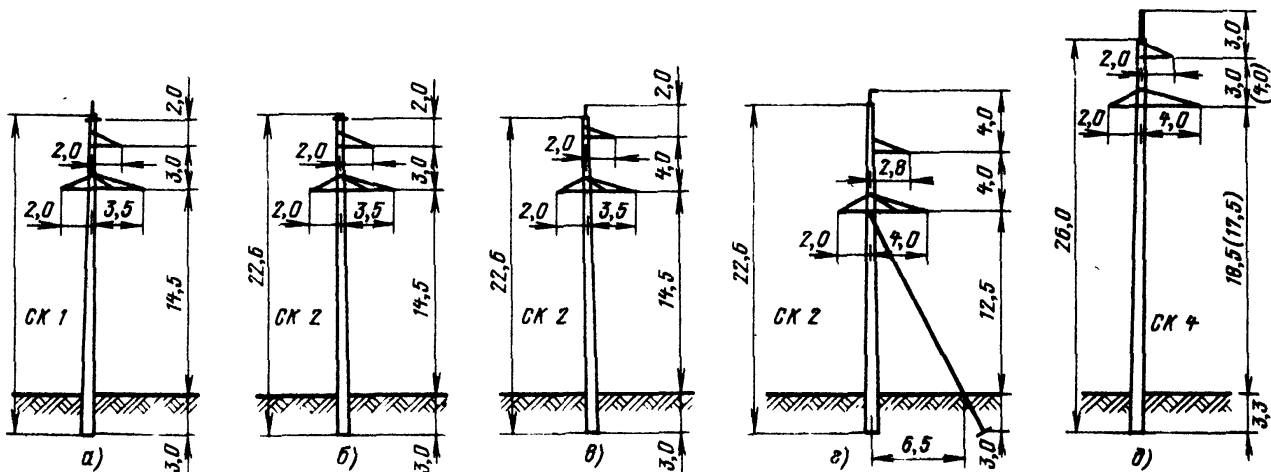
Унифицированные промежуточные железобетонные опоры 110 кВ
